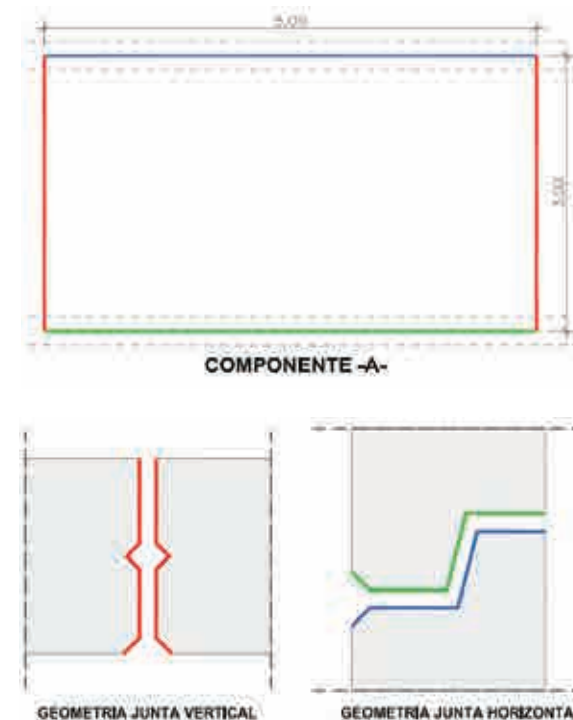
Geometría del componente plano v tipo de junta o borde perimetral
